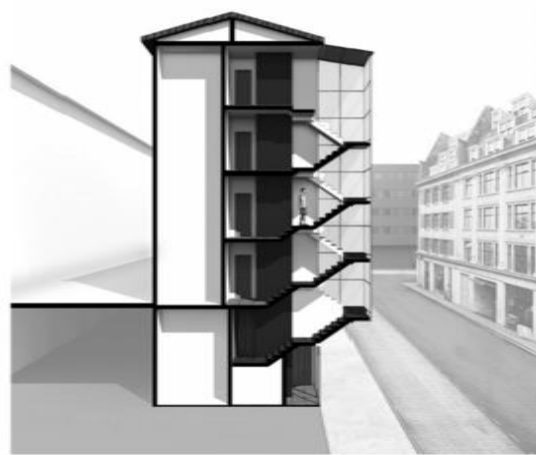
Imágenes en 3D de tipología de escalera rusa situada en patio interior y en fachada principal. Fuente: Elaboración propia.
